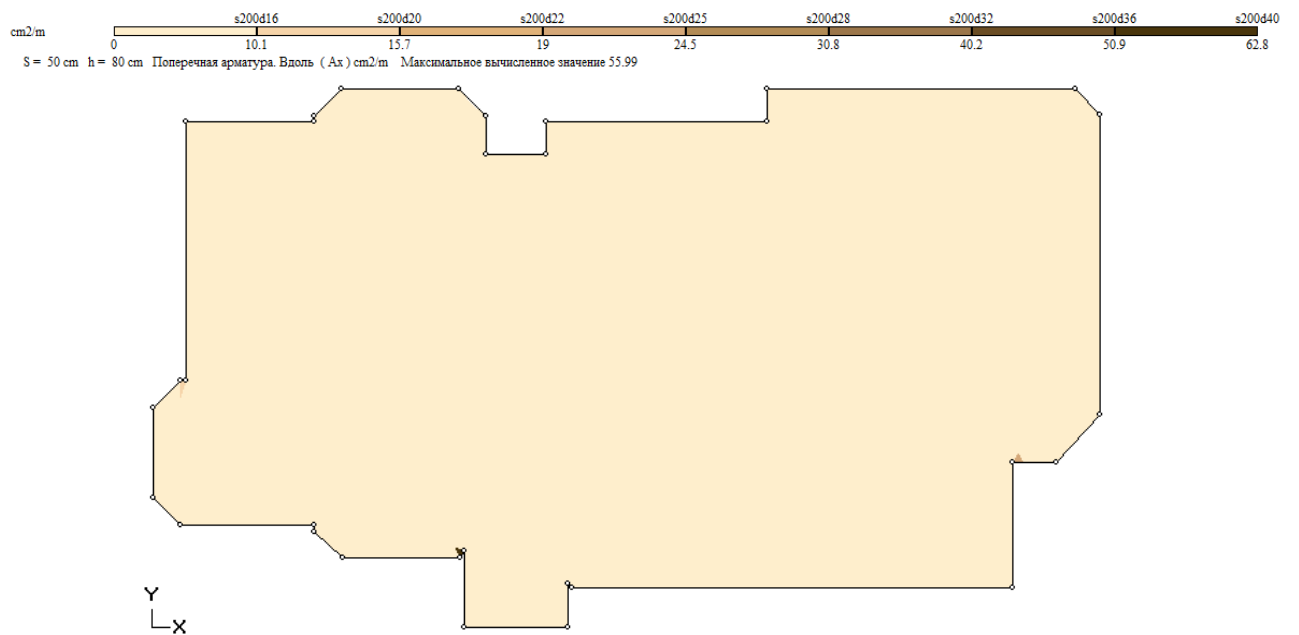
Поперечне армування плити у напрямку осі Х
